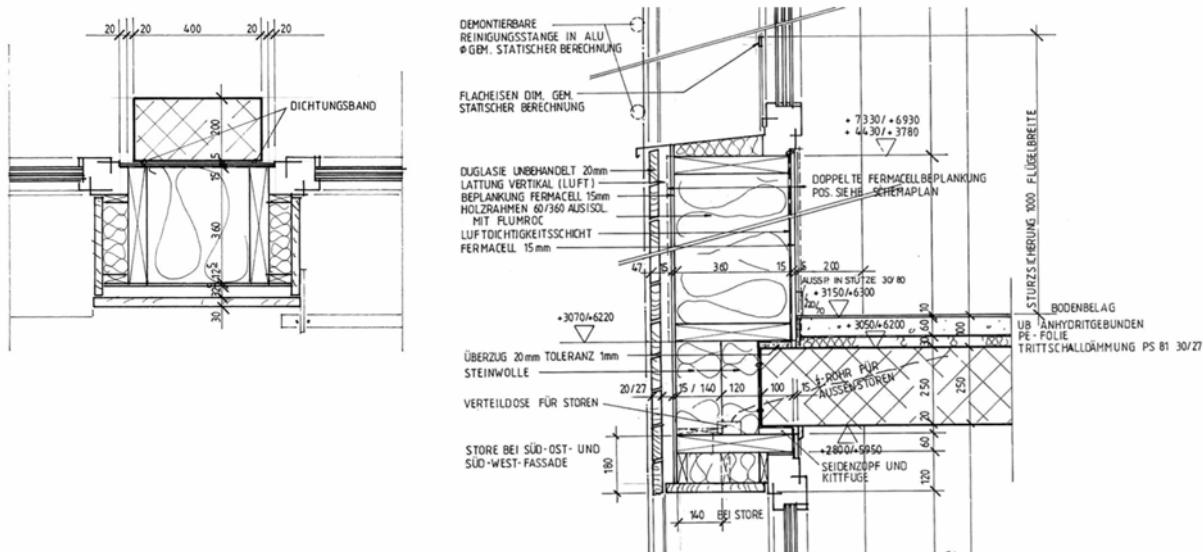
Grundrissdetail Stütze und Schnittdetail Deckenauflager im Passivhaus in Rapperswil
